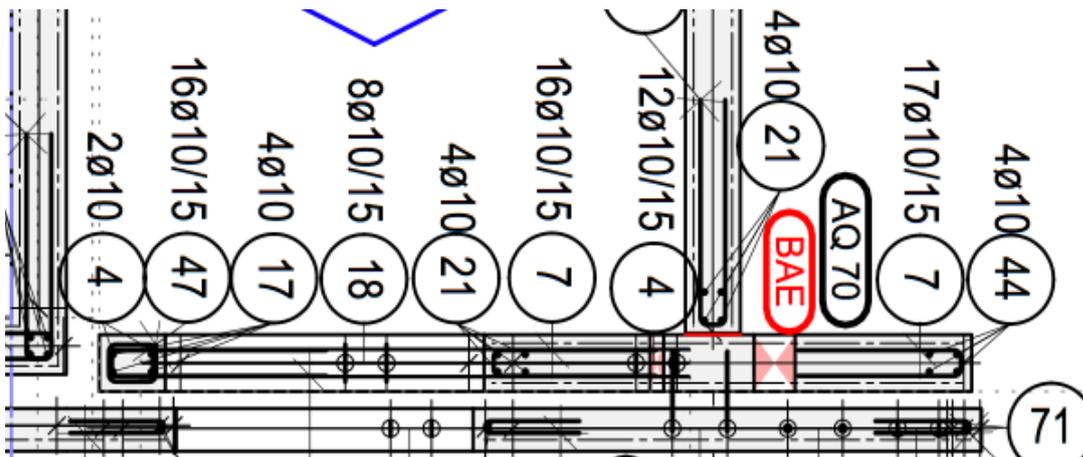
Bewehrungsplan des Statikers im Grundriss
